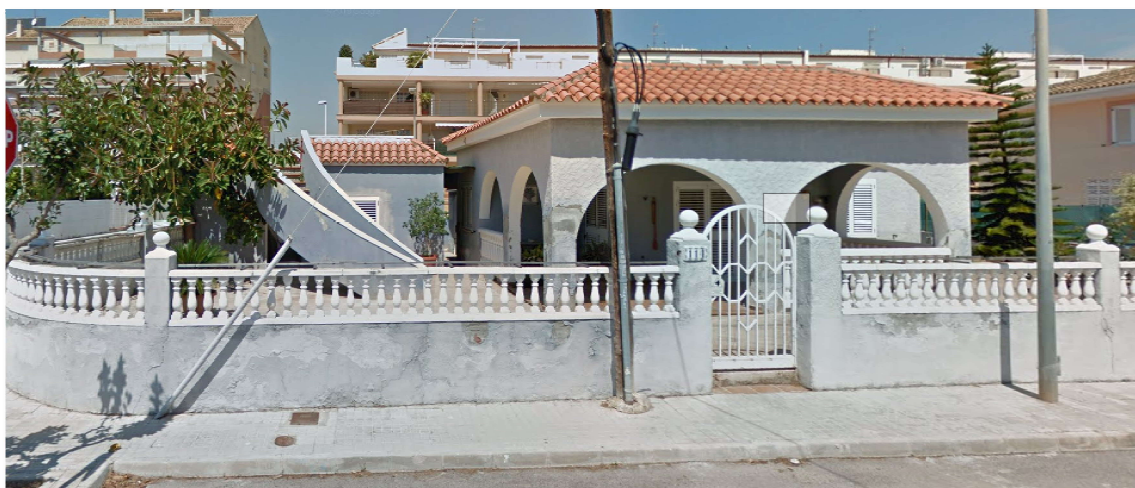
Fachada principal, calle Cerezo (Fuente autor)
